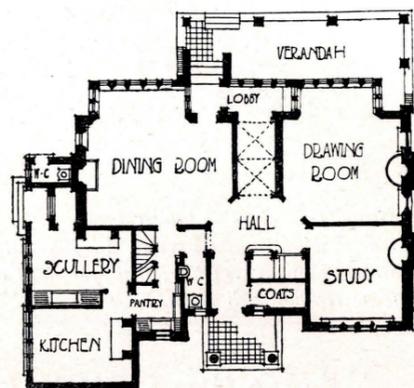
Pianta del piano terreno. Casa economica inglese a Cambe Warren. Arch. Jessop Hardwick. (*Der Architekt*, Marzo 1913).
